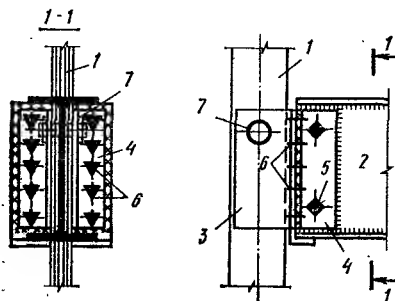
Узел крепления балочной клетки междуэтажного перекрытия к жесткой подвеске
